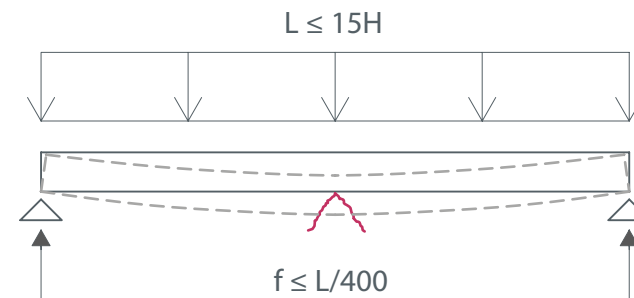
Holzbau Bemessungsfall 2 - Zugbruch durch hohes Biegemoment bei kleiner Durchbiegung, Träger zu steif
